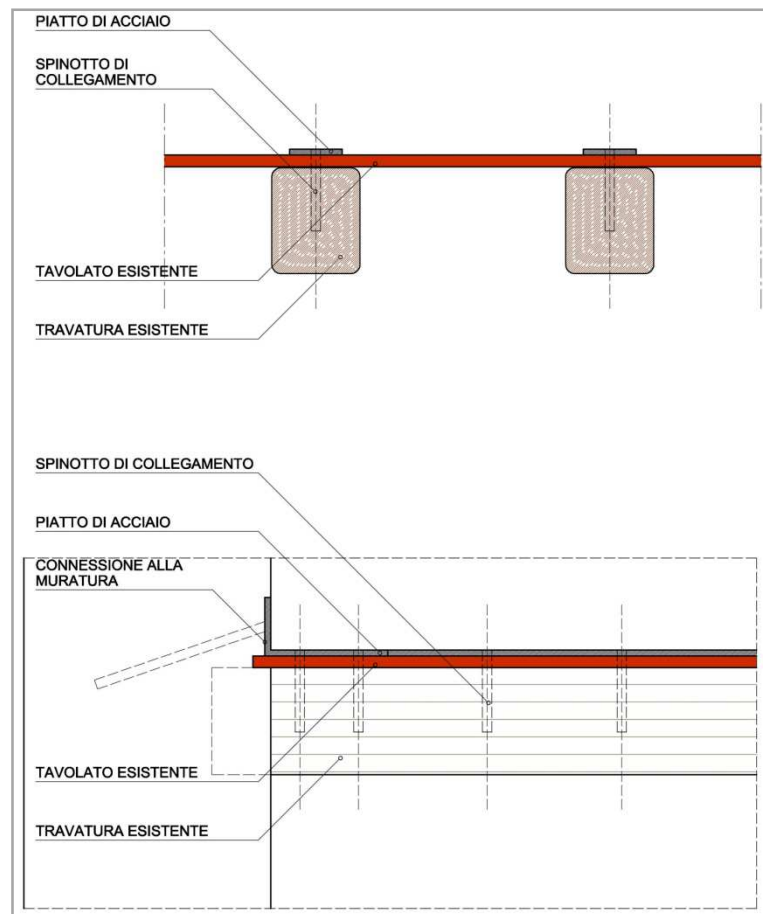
Sezione trasversale e longitudinale del solaio consolidato con piatti metallici.
